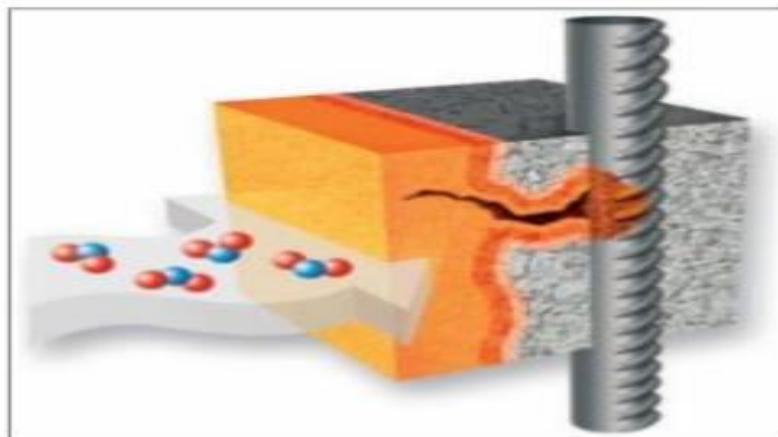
Ataque generalizado en la armadura debido a la corrosión por carbonatación.
